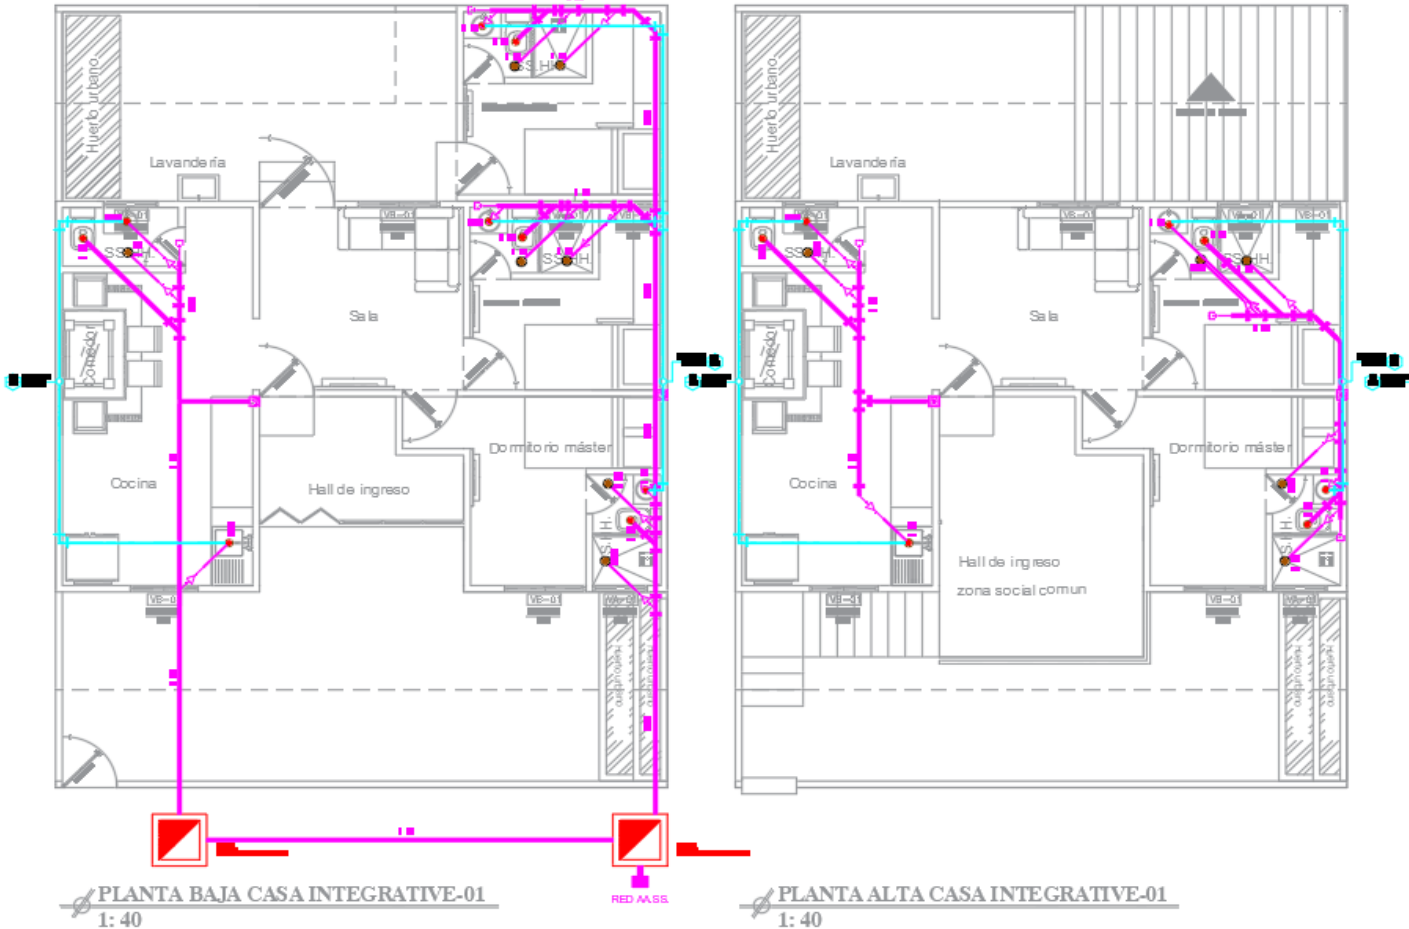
Plano bajantes de aguas lluvias cubierta
